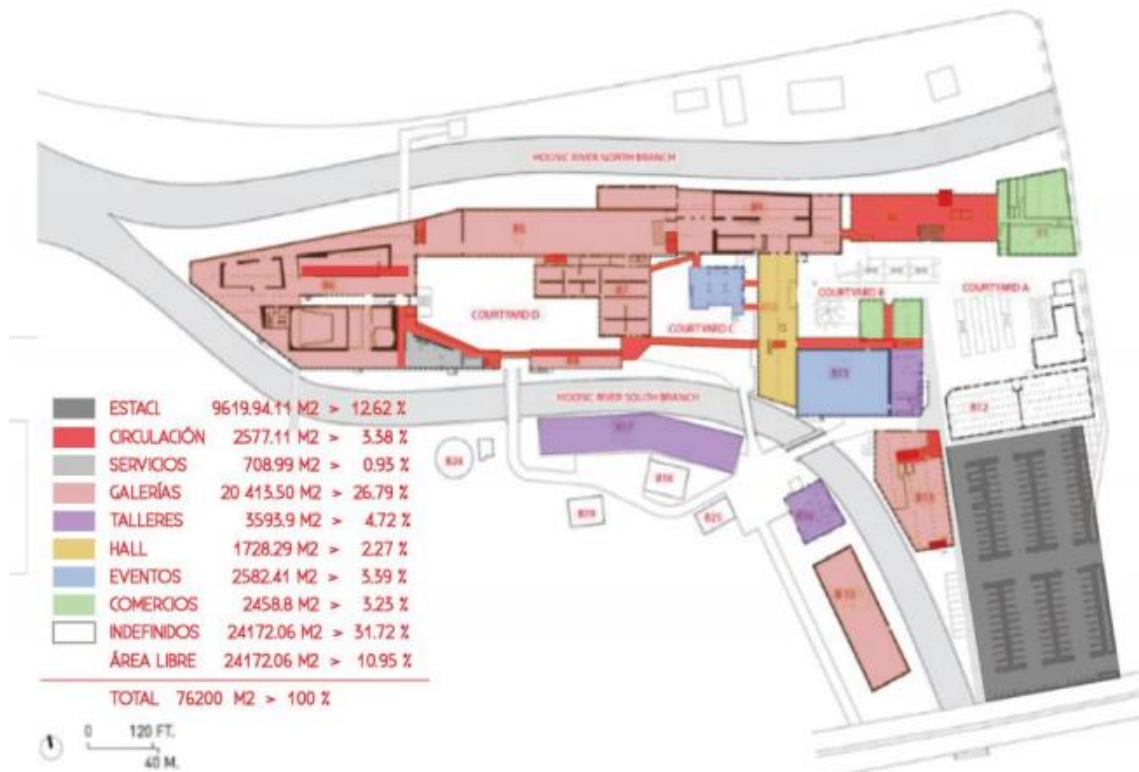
Plano de folleto intervenido con áreas por espacio - Elaboración propia
